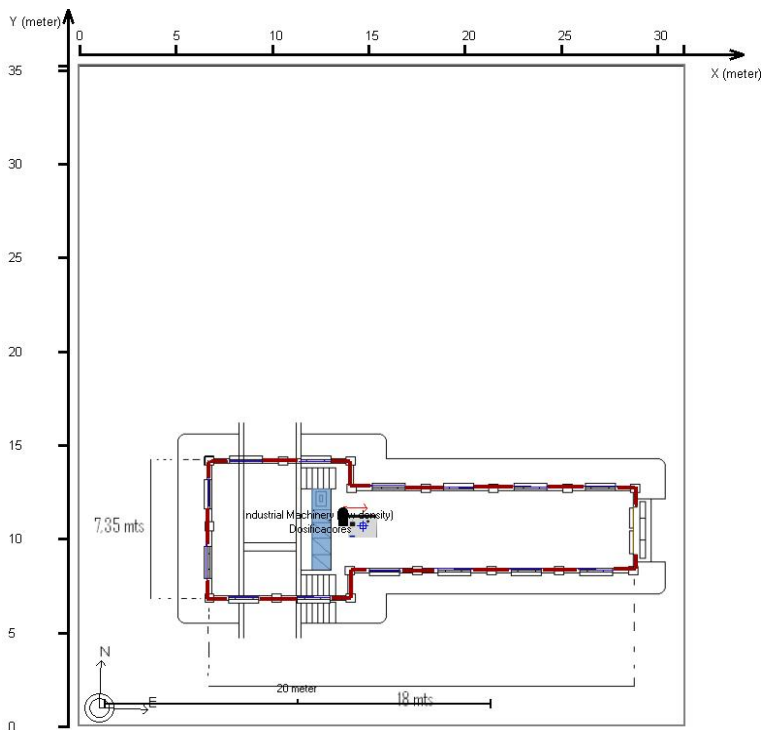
Floor Plan - Planta El Tablazo – Sala de dosificación
